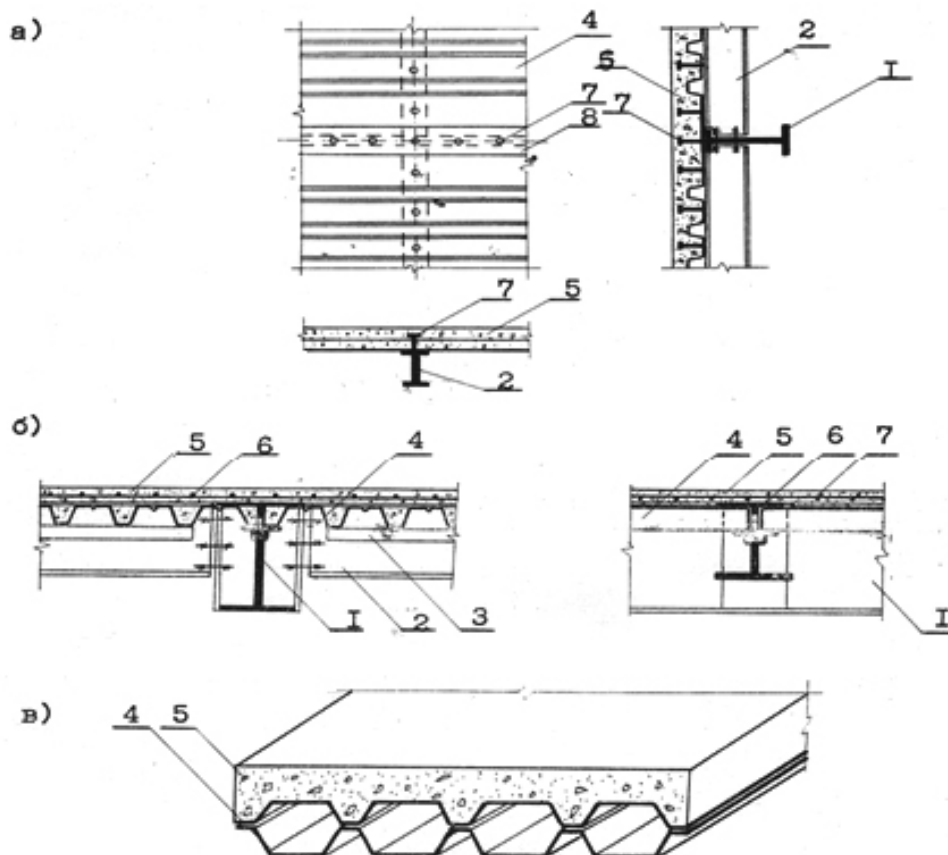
Конструкция перекрытий, применяемых в Чехии и Польше.
